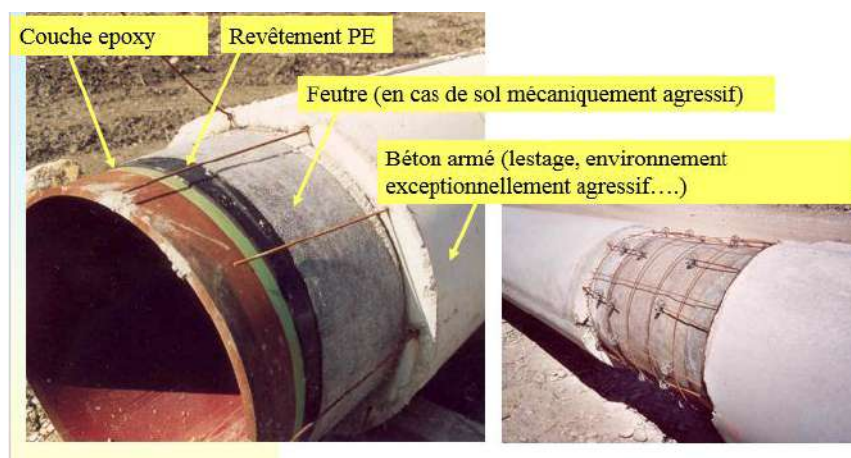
Isolation du réseau des autres structures étrangères enterrées
